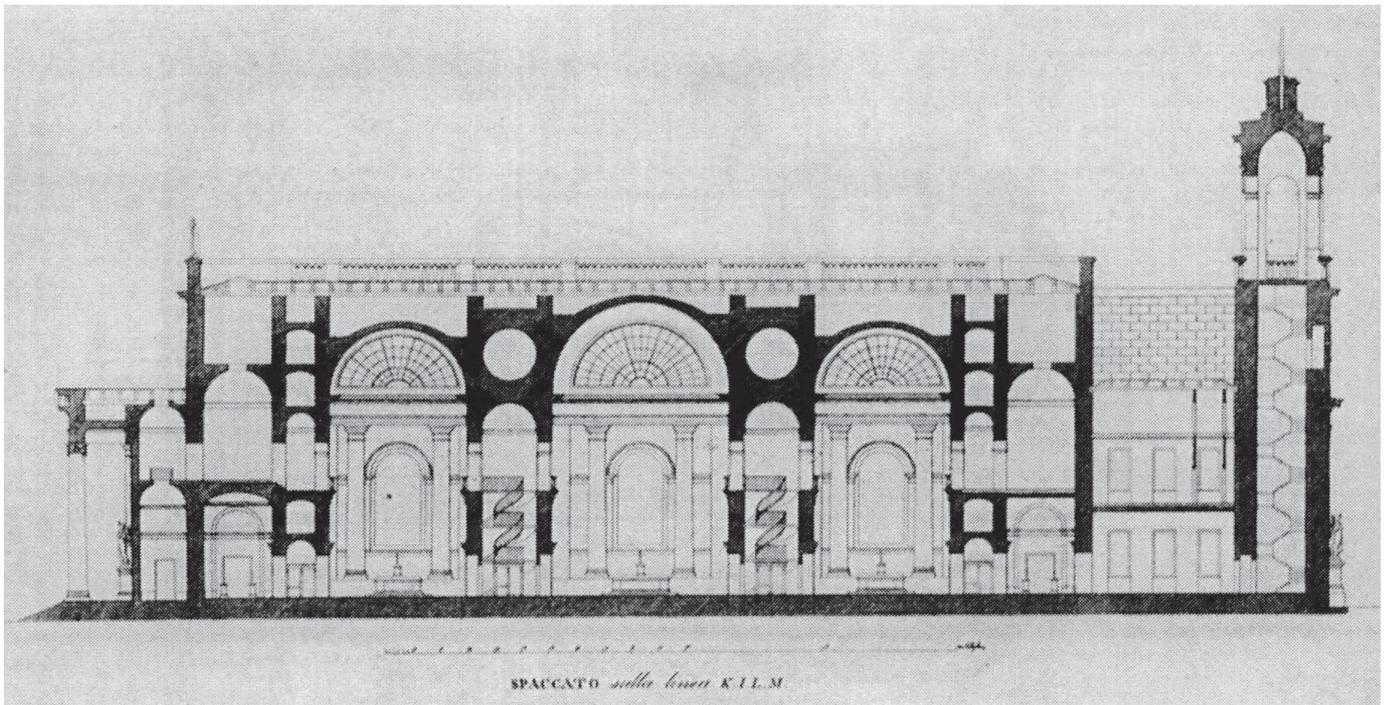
Pietro Nobile, sezione longitudinale (1823).
